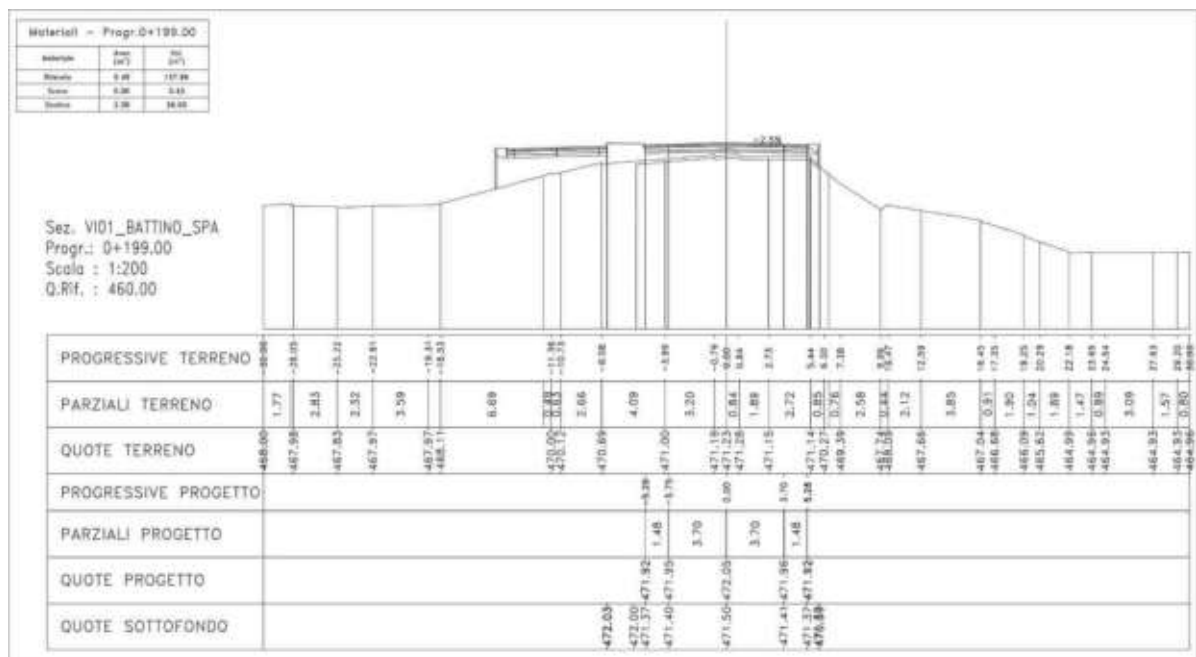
Sezione trasversale di progetto VI01_Viadotto Rio Battino
